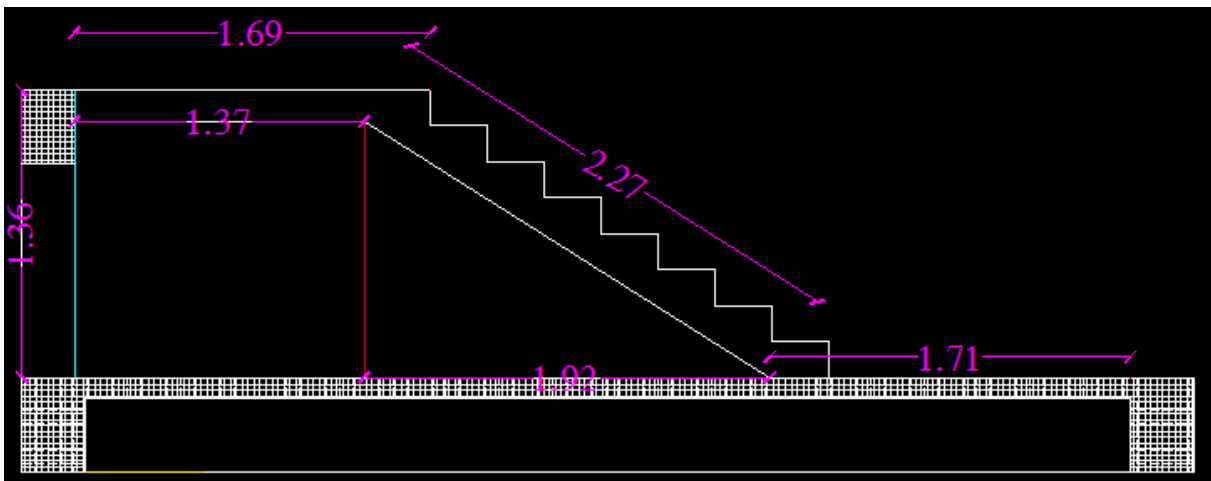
Coupe vertical d'une volée de l'escalier.
